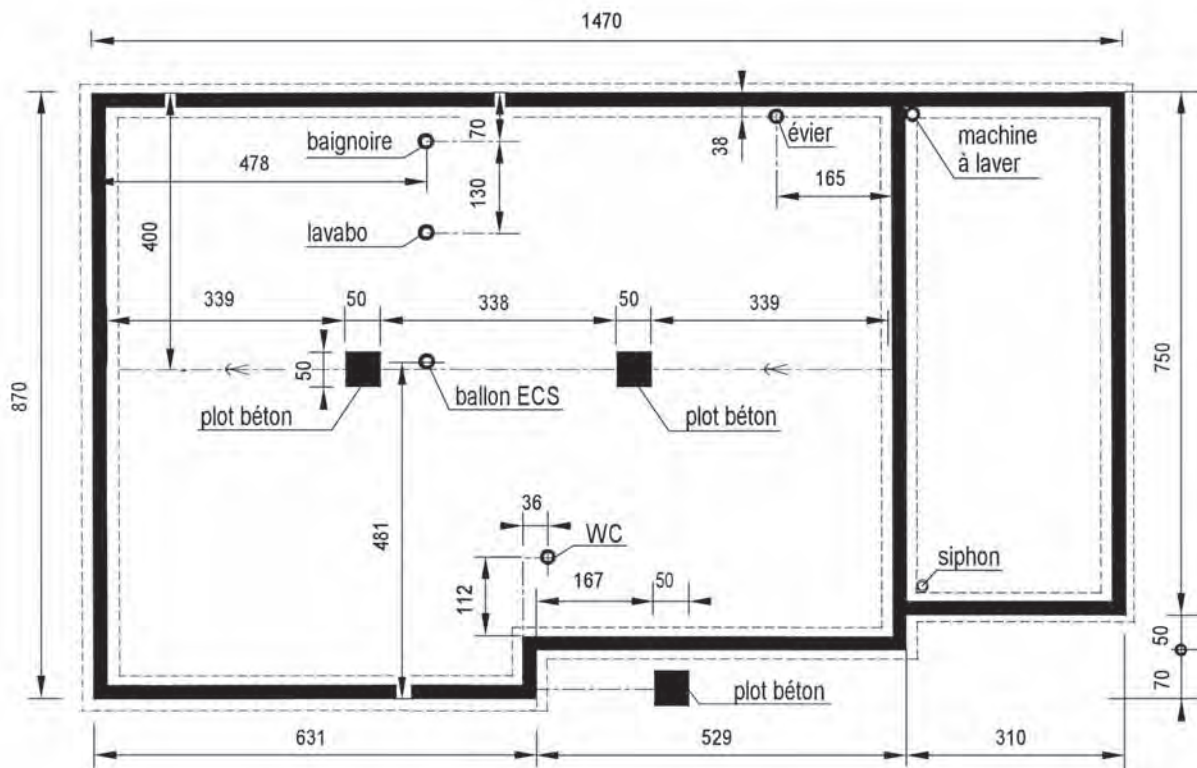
Fondations (semelles filantes et plots bétonnés) et repérage des évacuations EU-EV
